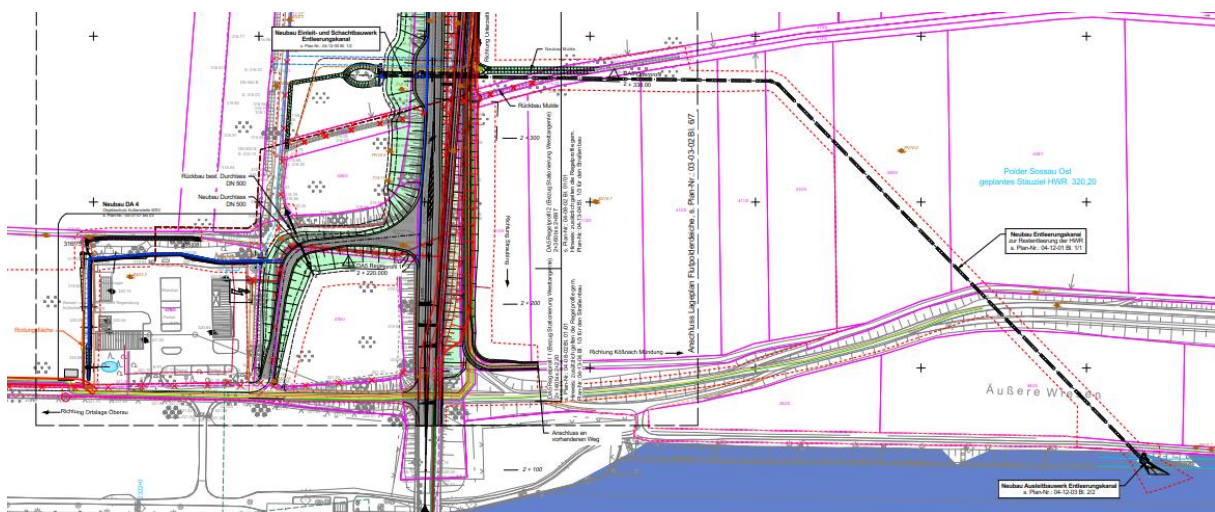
Entleerungskanal Polder Sossau, Lageplan (aus Plan 03-02-01, Blatt 4/4)
